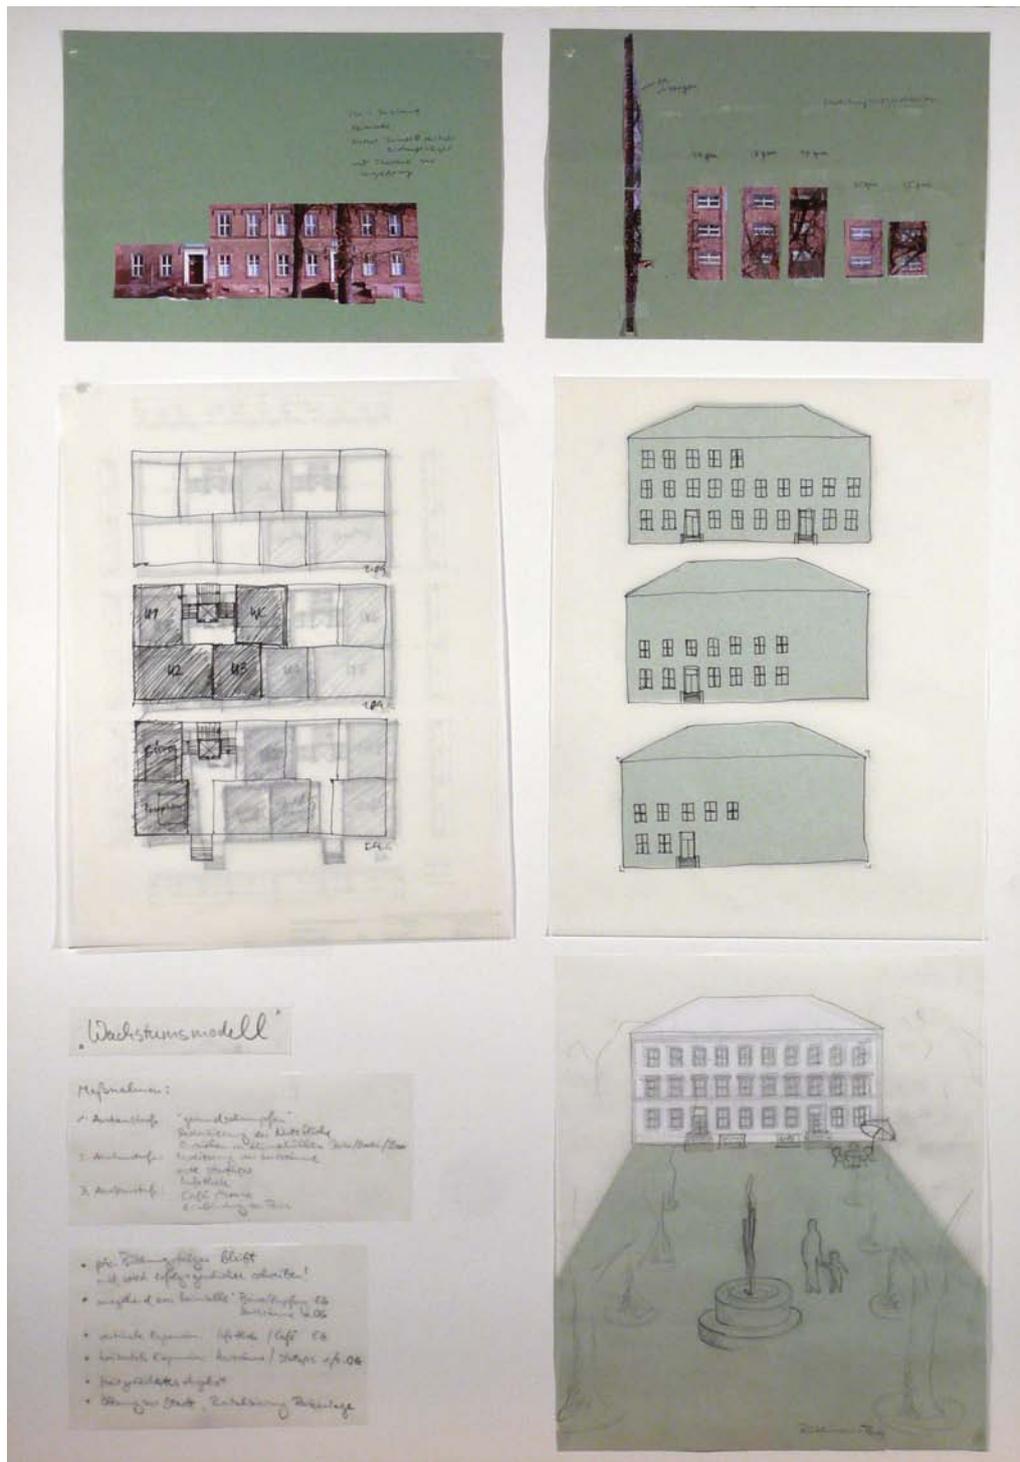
Rühlemannschule Grundrisse und Ansichten
